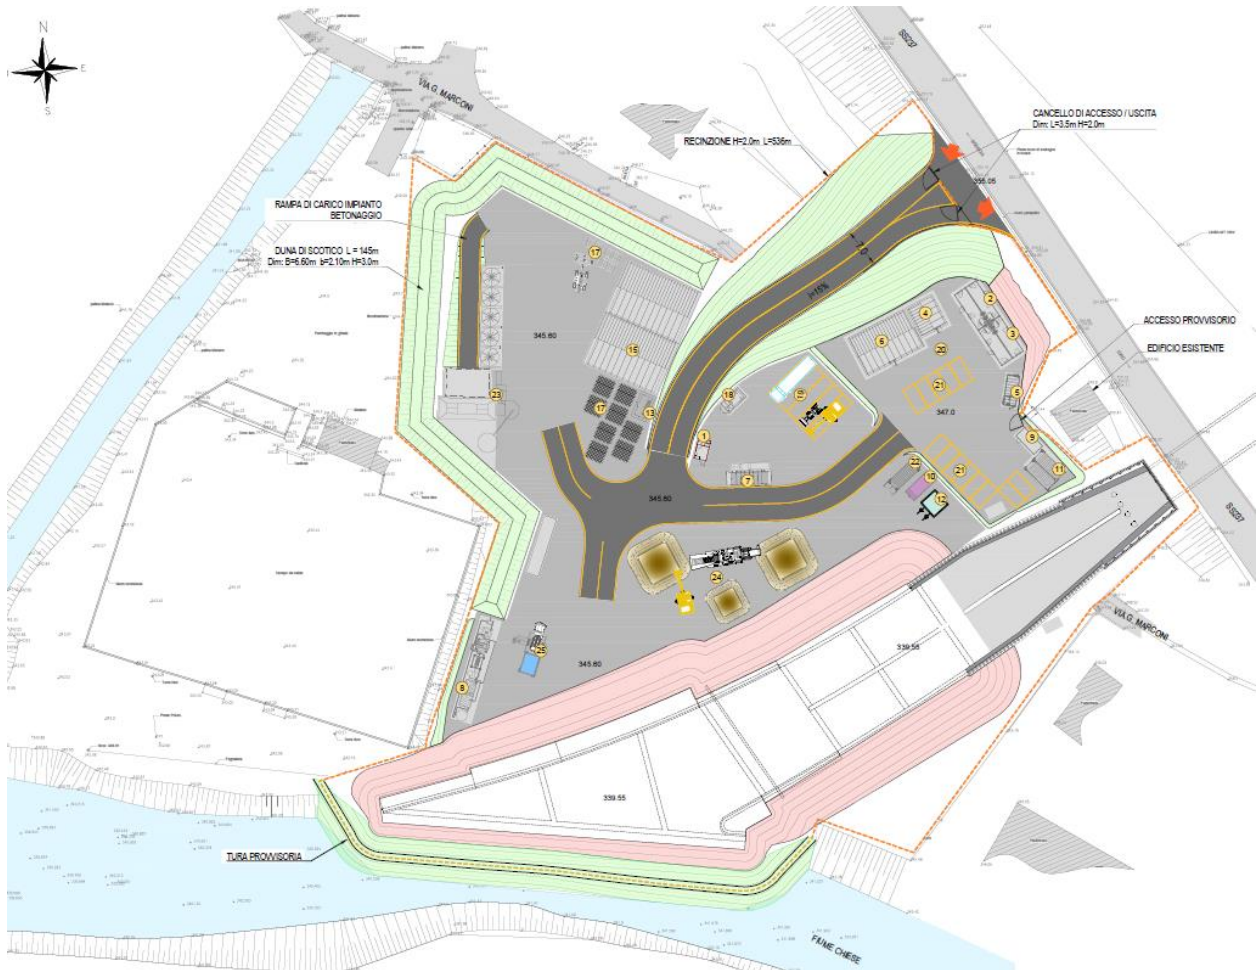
Planimetria dell'area cantiere zona sbocco galleria – Fase 2 Realizzazione manufatto di sbocco
